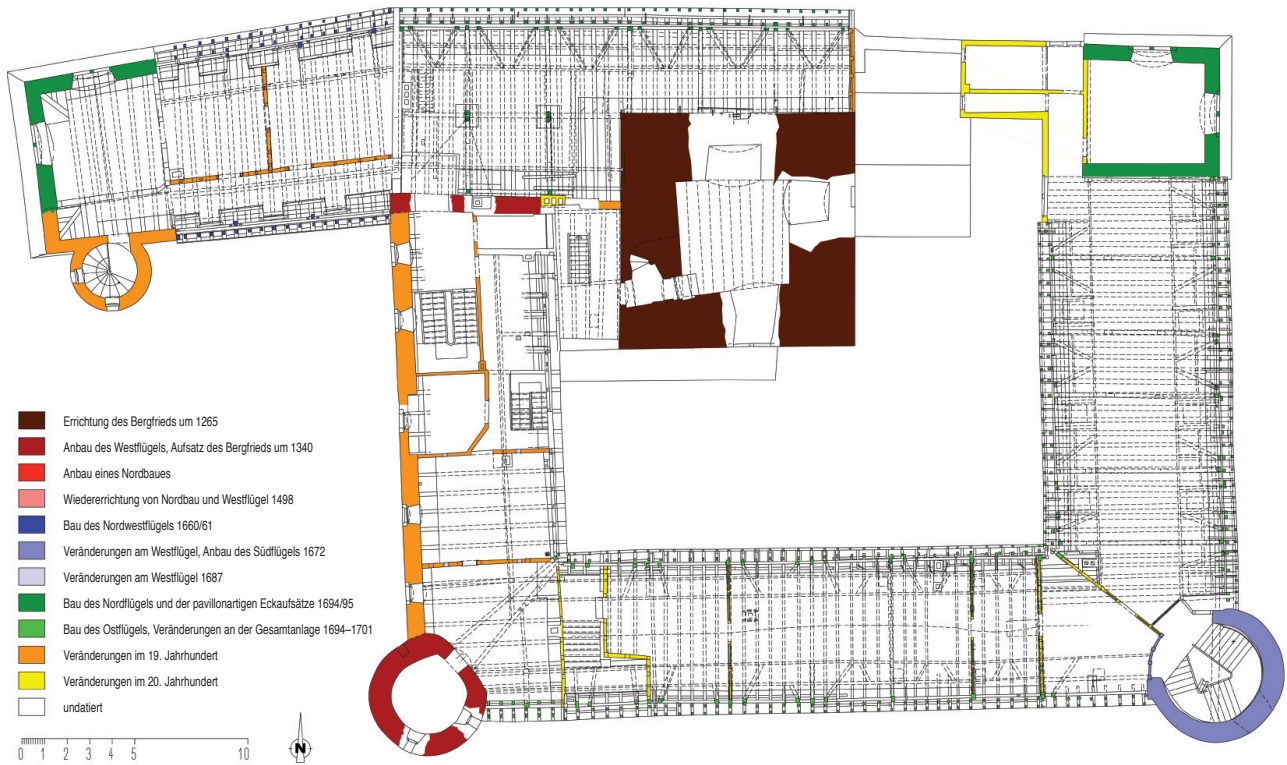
und 11. In den Grundriss des Dachgeschosses und des fünften Obergeschosses wurden die einzelnen Bauphasen farbig eingetragen (Maßstab ca. 1:350, Zeichnung: Verf.).
